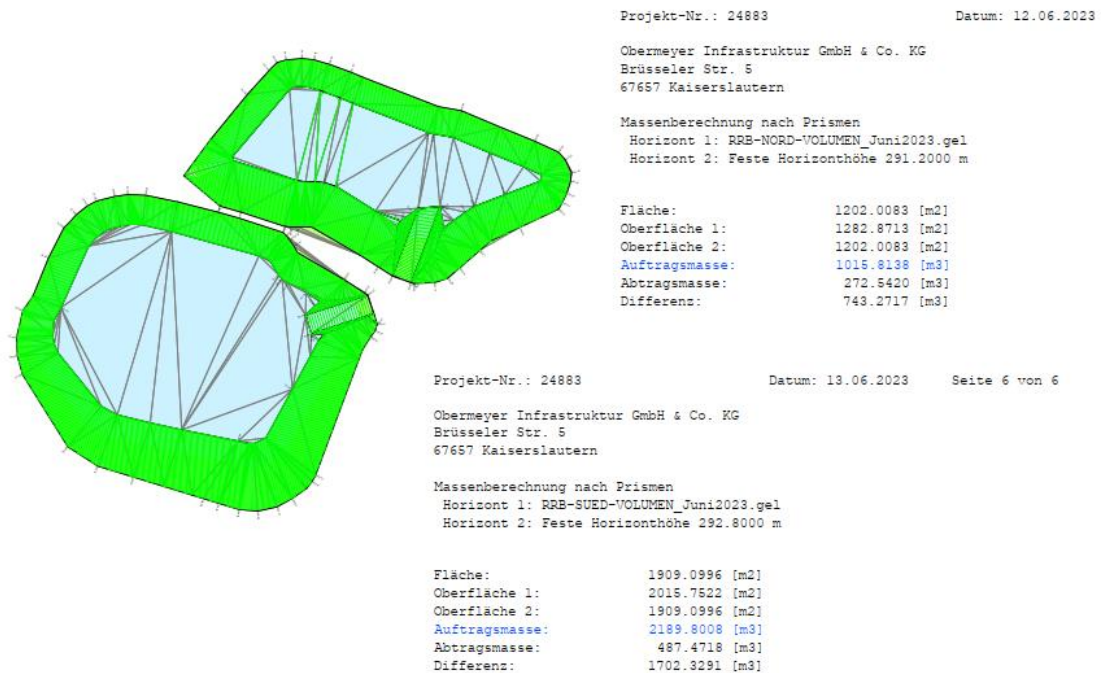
Volumenermittlung RRB (Quelle: ProVI)
